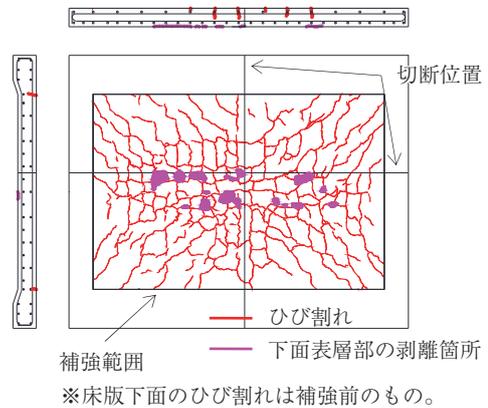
試験後の剥離状況とひび割れ状況 (A1)
